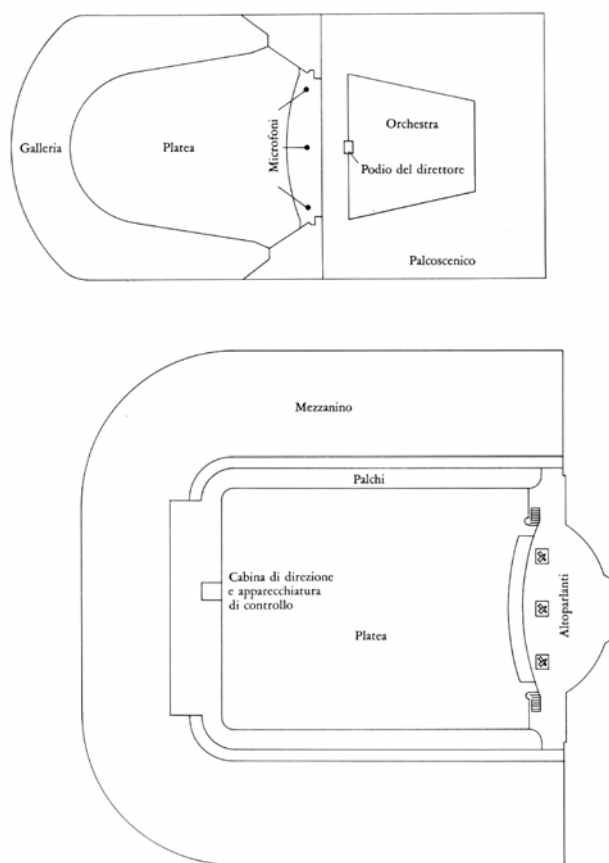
Pianta dell'Academy of Music di Philadelphia (in alto) e della Constitution Hall di Washington
